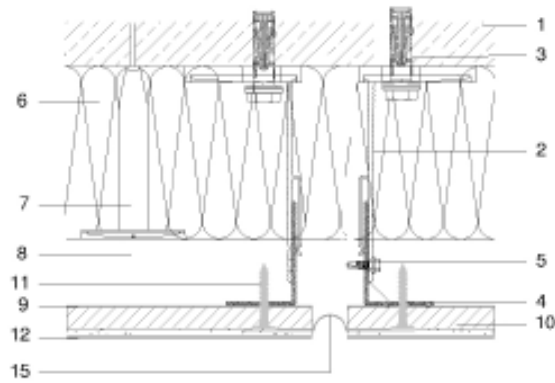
Detalhe construtivo de junta vertical do sistema (junta de controle) [78].
